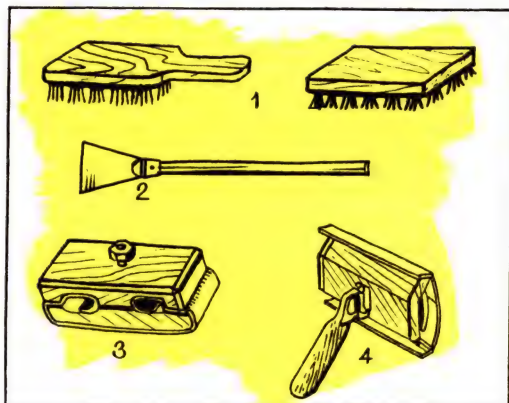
Инструмент для очистки поверхности: 1 — щетка; 2 — скребок с удлиненной ручкой; 3 — колодка для шлифовальной шкурки; 4 — приспособление для шлифования поверхности
